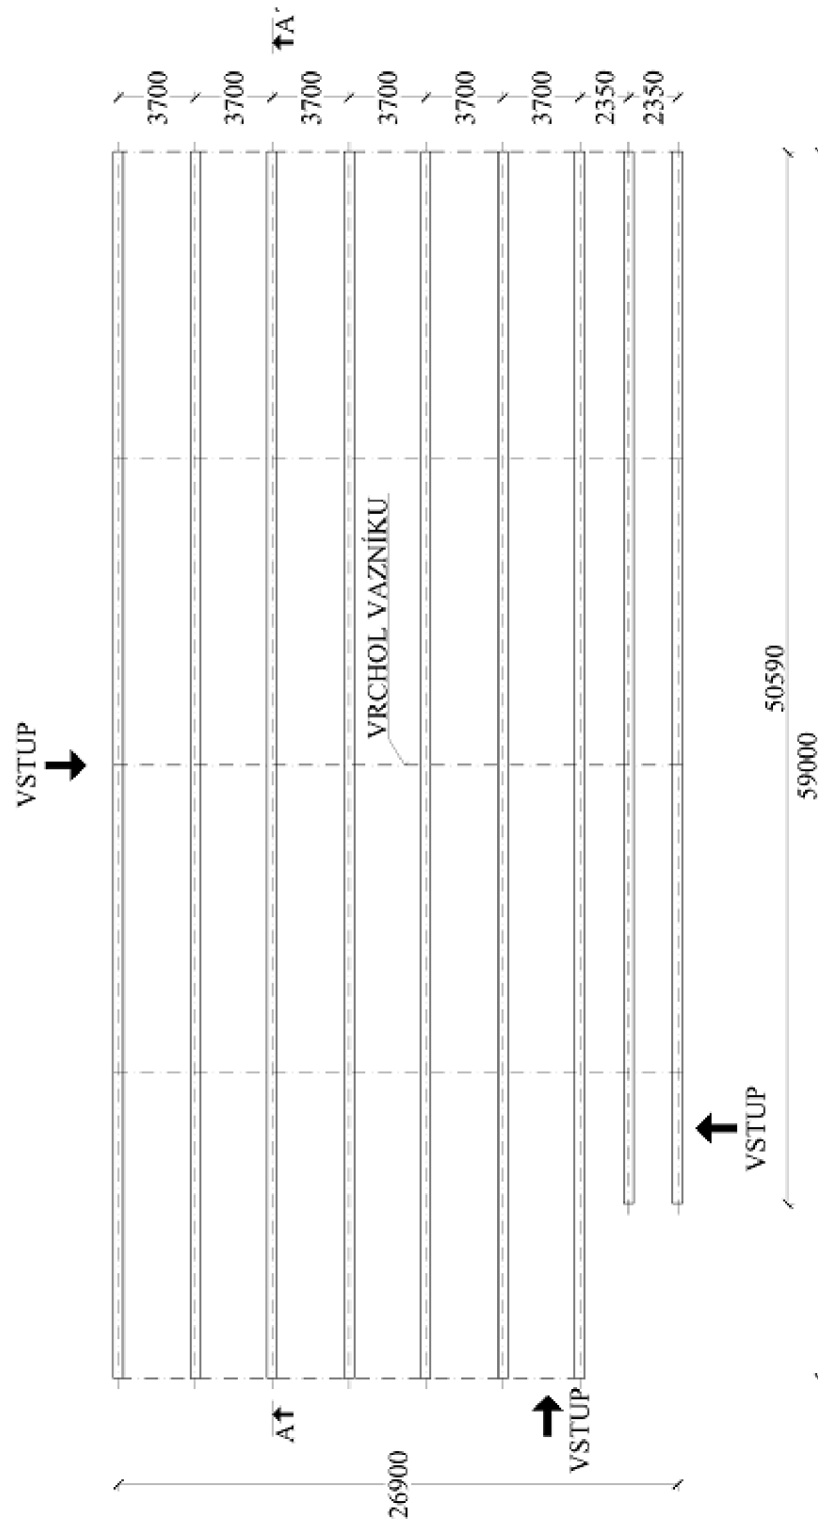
Konstrukce zastřešení během výstavby [14]
